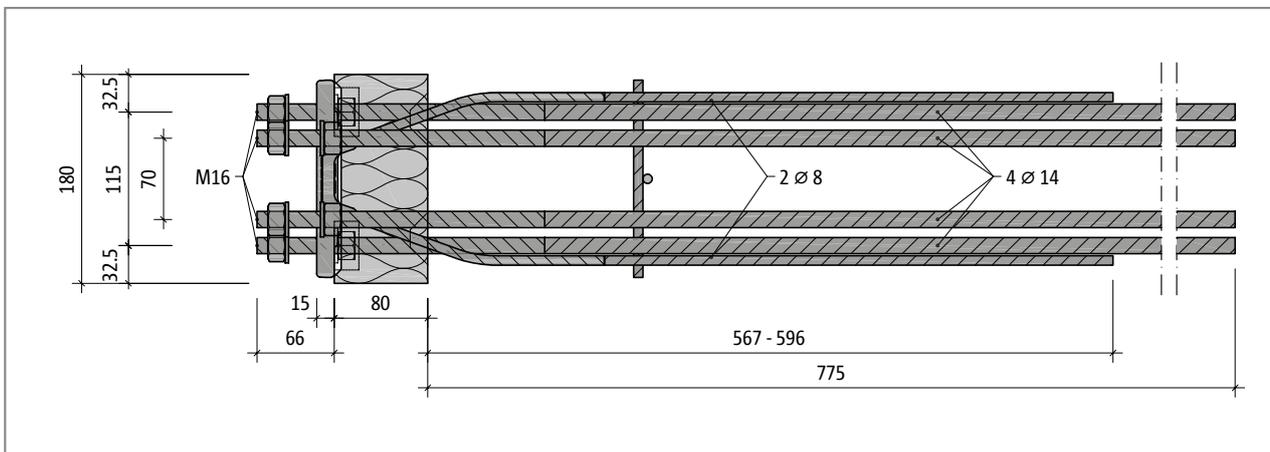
Schöck Isokorb® T type SK-MM1-VV1: Plan view
